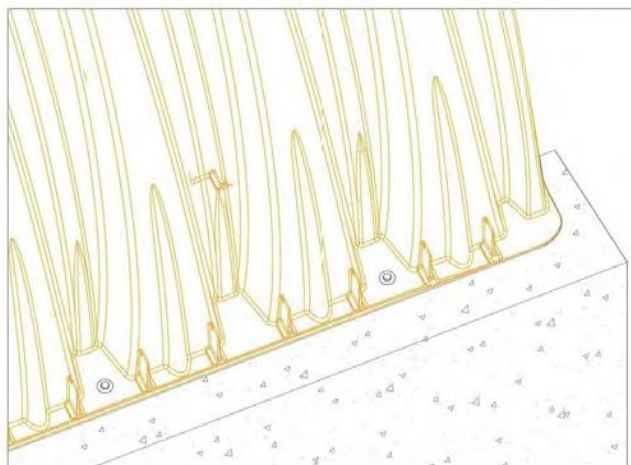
Ejemplo de cimentación de cámaras StormTech®
